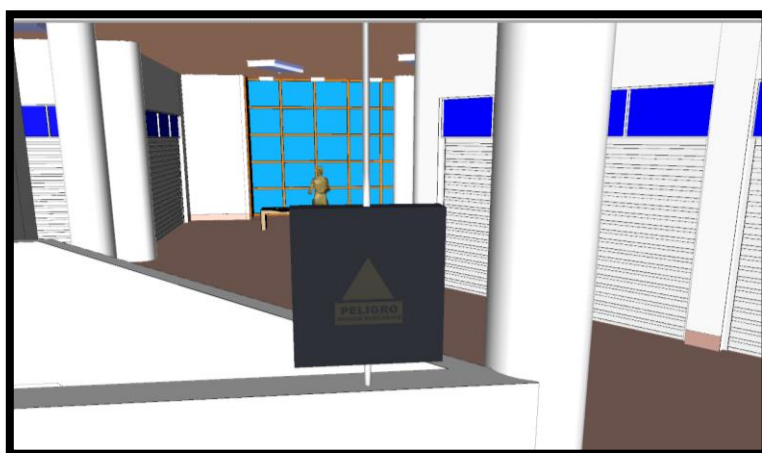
Incompatibilidad entre columna en plano de estructuras y arquitectura
